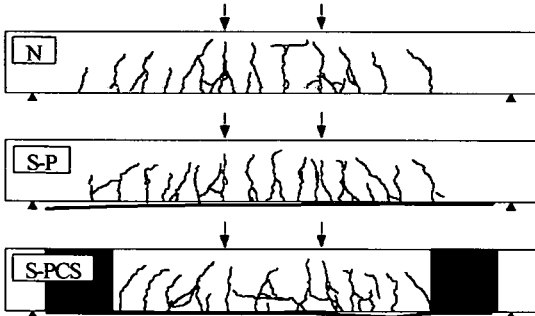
ひび割れ状況図(静的曲げ試験終了時)
